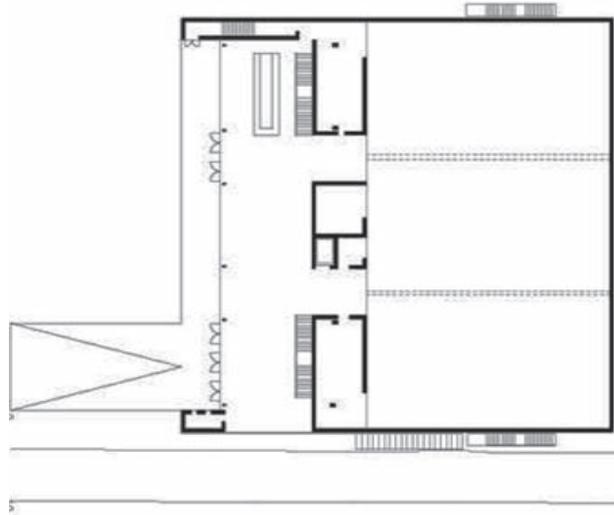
Grundriss Ebene 00 - Mehrzweckhalle Kirchdorf
